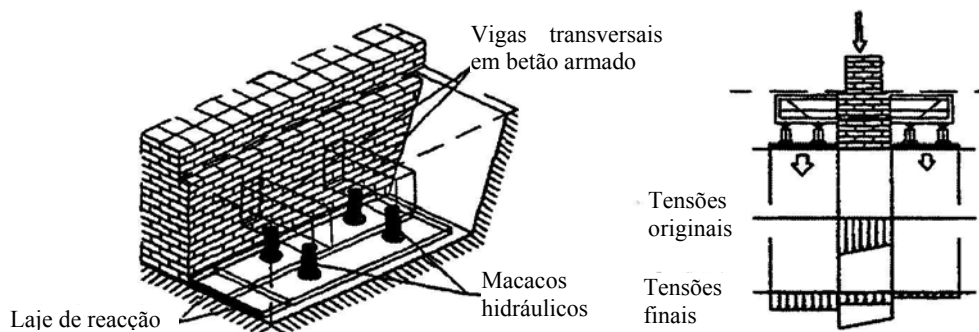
Transferência parcial das cargas da fundação existente para lajes de reacção adjacentes através de macacos hidráulicos apoiados em vigas transversais de betão armado.
